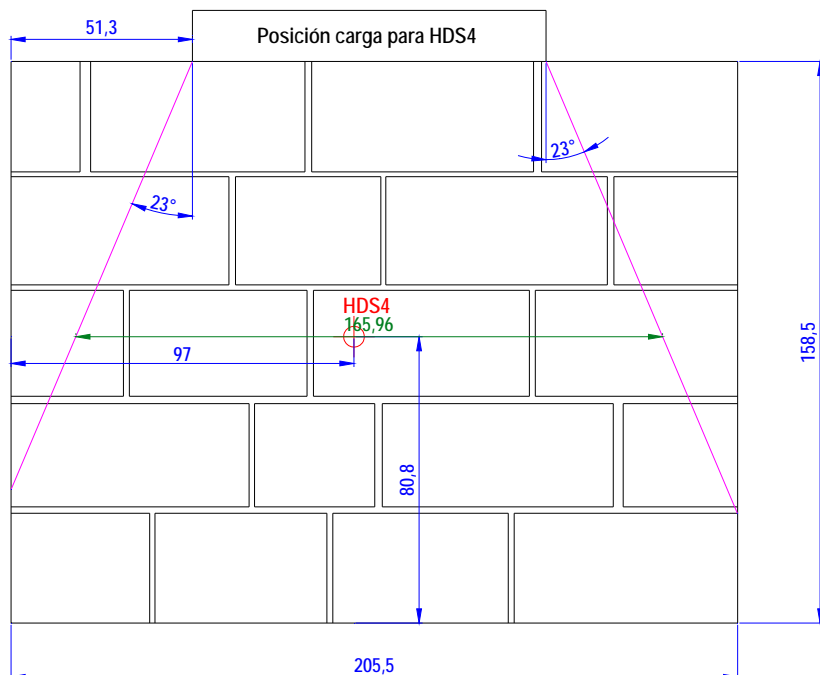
Alzado del muro de sillería con la localización del HDS4. El espesor del muro son 31 cm. Las cotas referidas son en cm.
